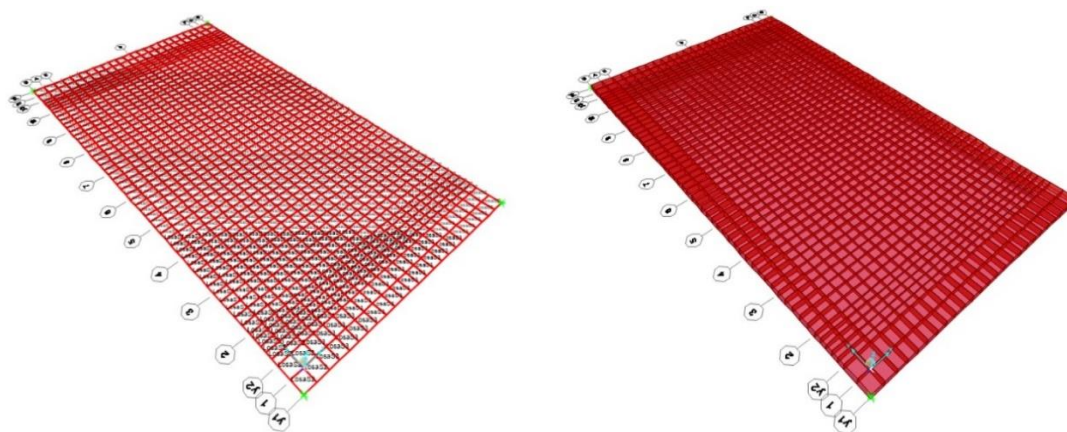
Modelo de losa de canto variable. Vista de mallado (izquierda) y vista extruida (derecha). Fuente: Propia.
